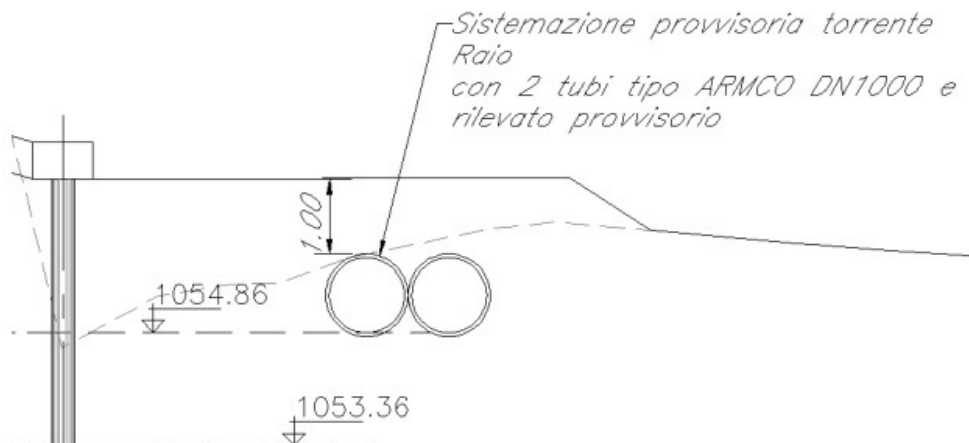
Sezione della Sistemazione provvisoria pila n. 6
